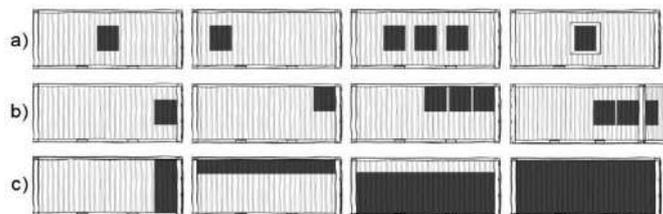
| a) Aberturas nos planos, b) aberturas nas esquinas e c) aberturas entre os planos
